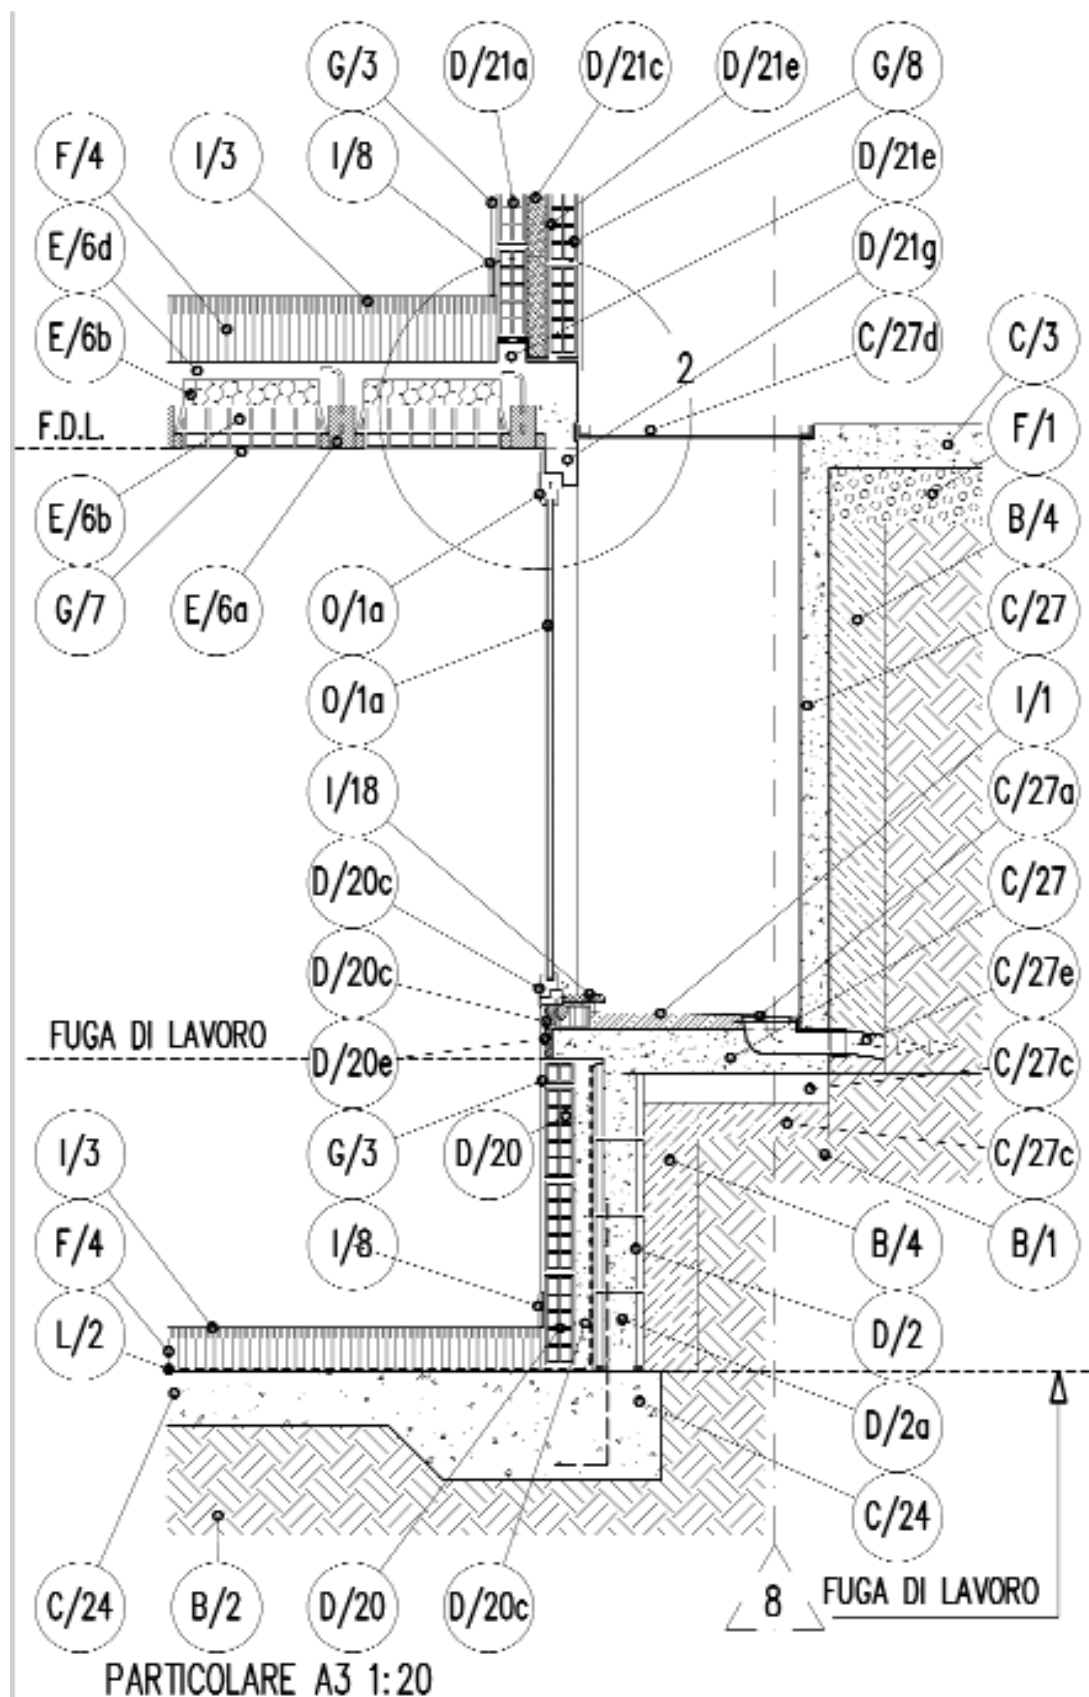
Sezione muro contro-terra attraverso bocca di lupo.
